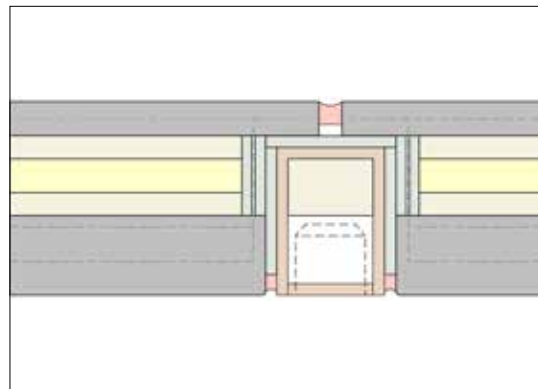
Fassaden-Sandwichelemente (FSE), Einbindung Elektro (kbp)
